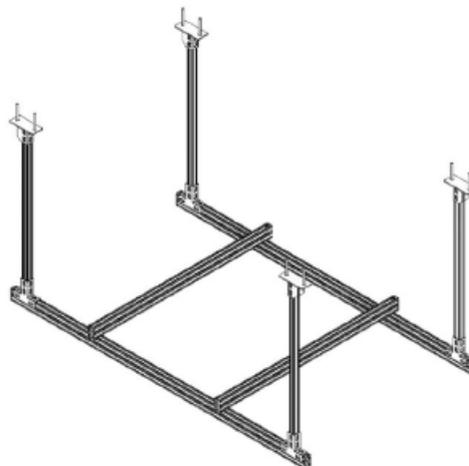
Beispielhafte Darstellung einer Stahlkonstruktion
